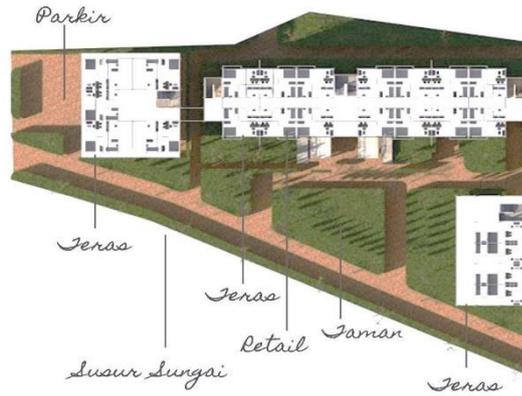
Konsep Tata Ruang Lantai Dasar
